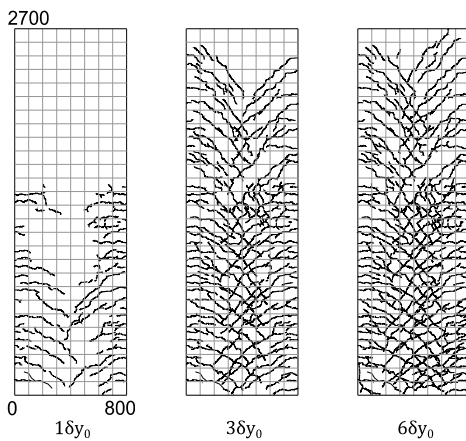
$6\delta y_0$ 時のひび割れ性状(Unit:mm)
